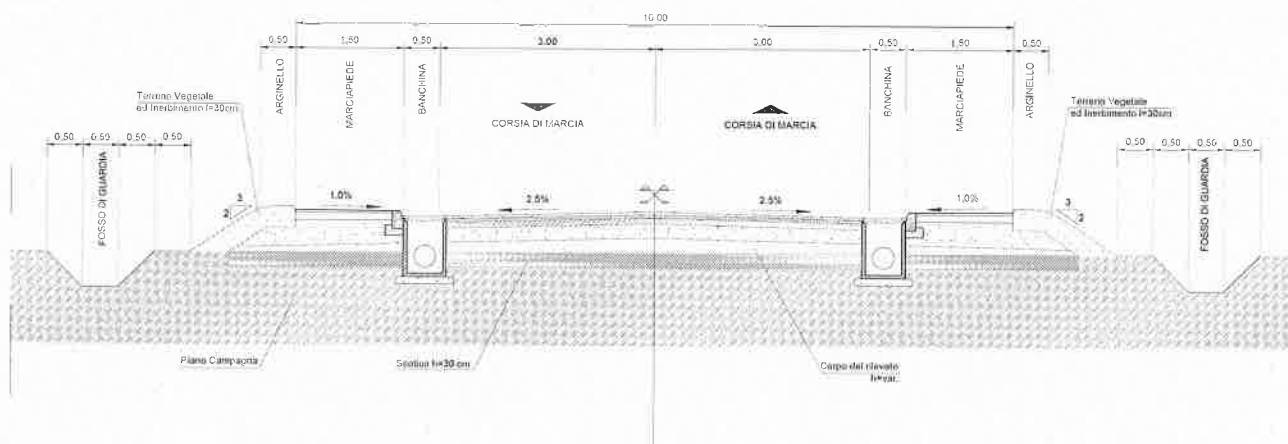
Sezione Tipo Rilevato tratto a 2 corsie
